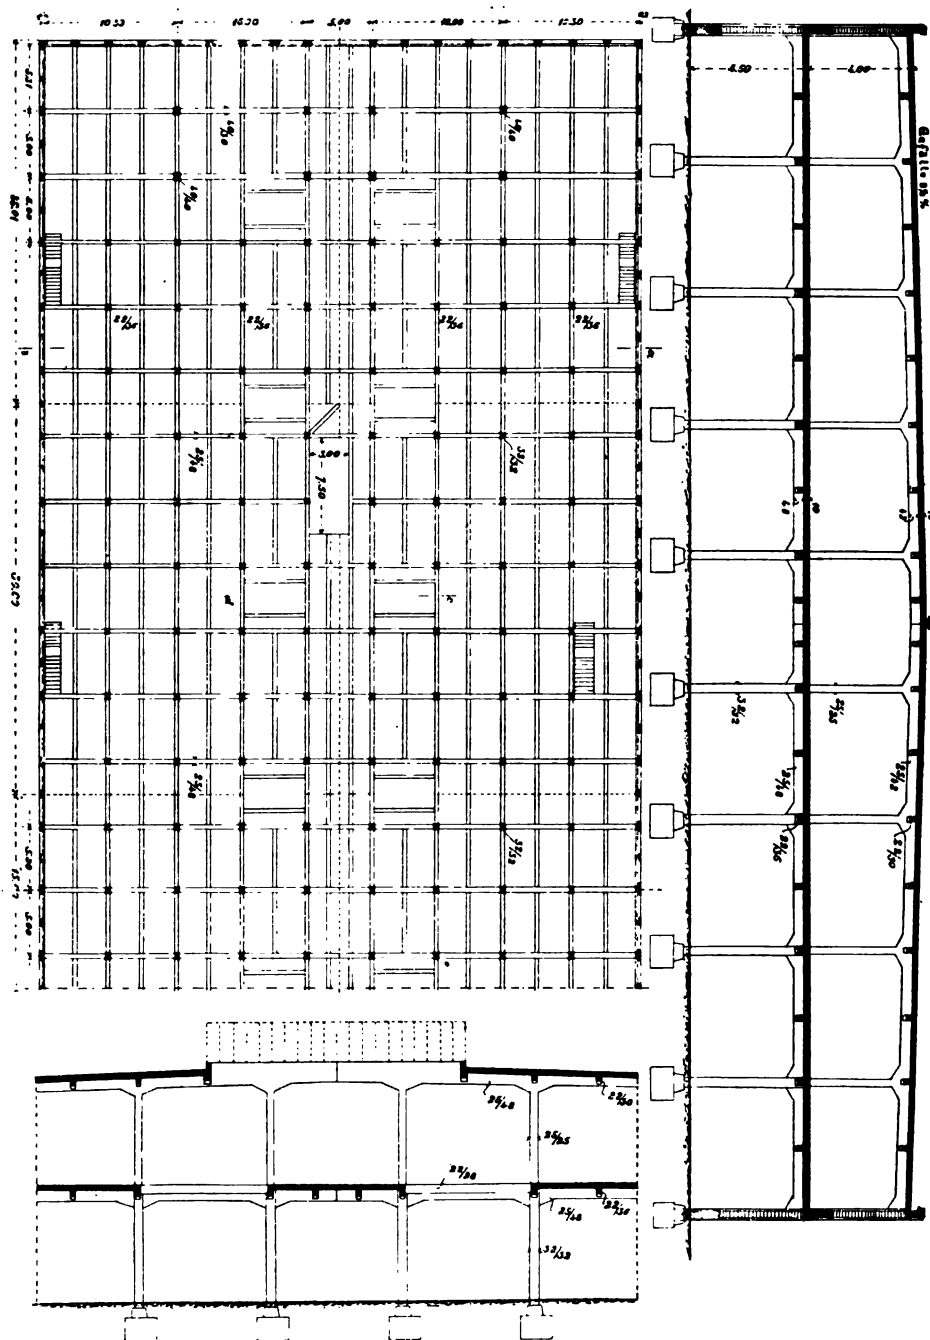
zeigt einen Teil des Grundrisses der Erdgeschoßdecke, Abbildung 211 einen Querschnitt des Gebäudes, das eine Länge
